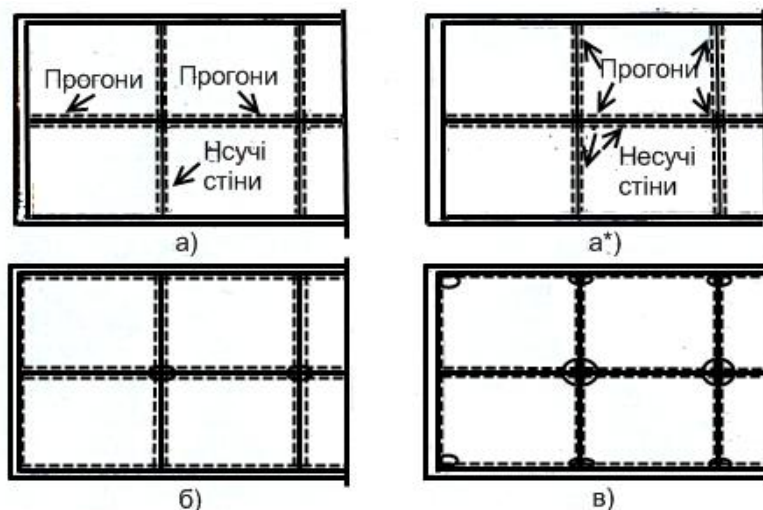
Схема з повздовжніми і поперечними несучими конструкціями.
